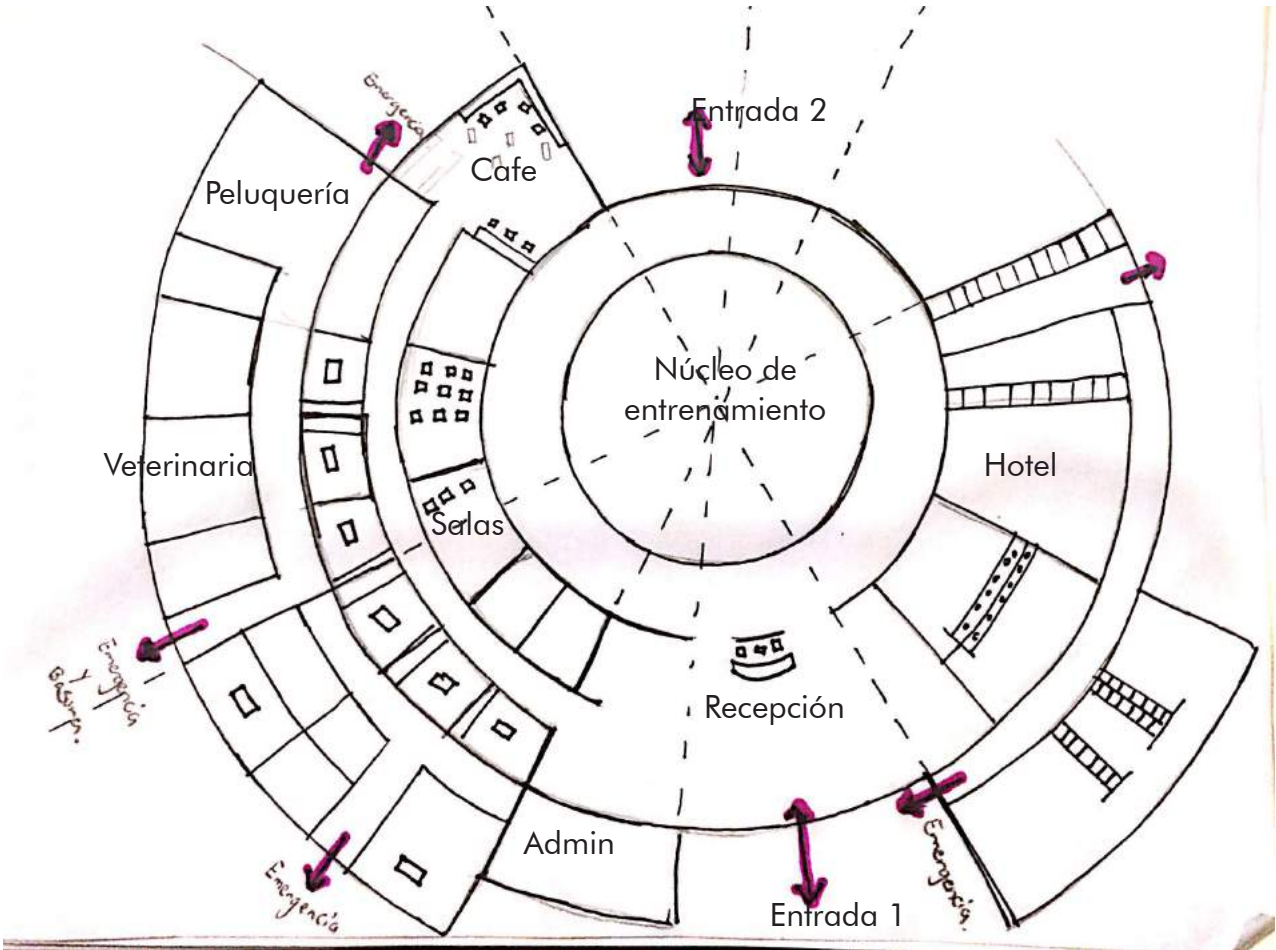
y 33: Planta emplazamiento y croquis de proyecto
